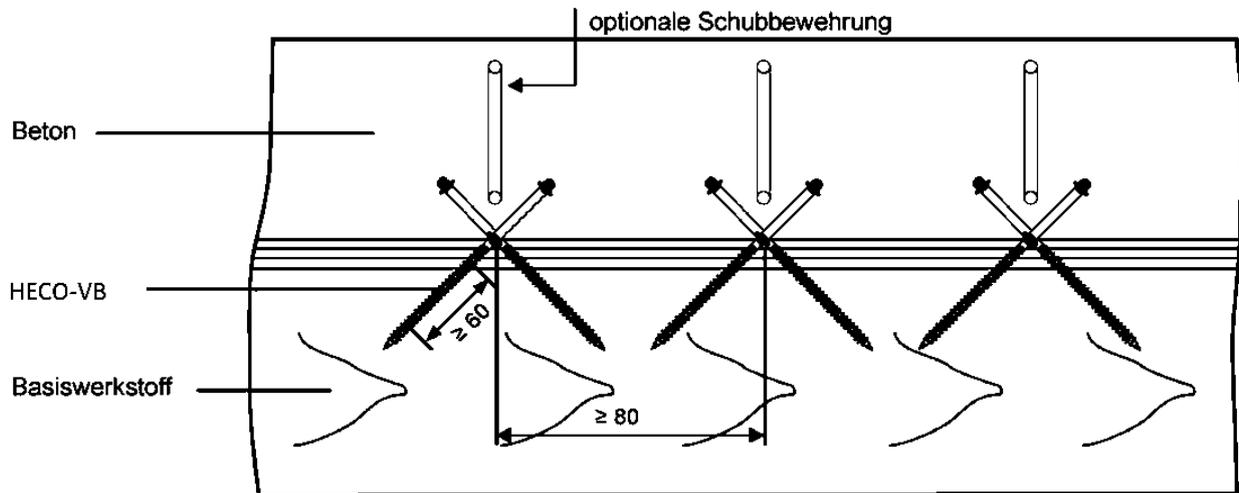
Prinzipielle Ansicht einer Holz-Beton-Verbundkonstruktion mit HECO-VB Schrauben
